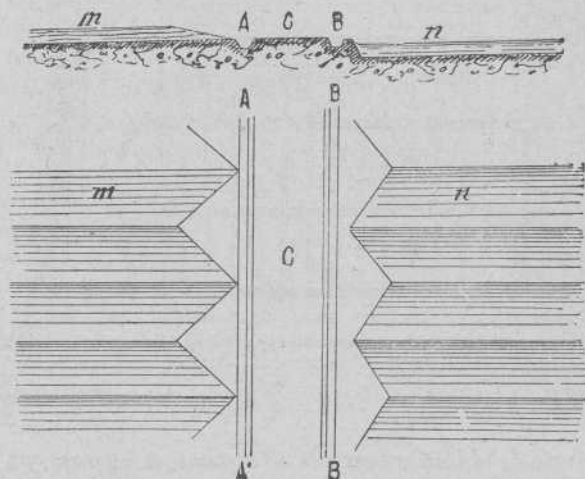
Corte y planta de la porción de terreno en donde terminan los tablares de un piso superior y donde empiezan los de un piso inferior
